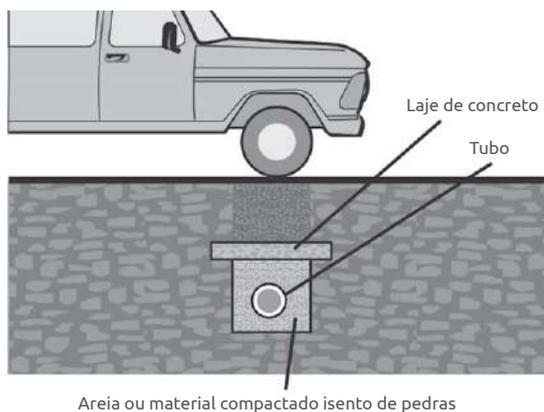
Detalhe de proteção adicional para tubulações sob carga
